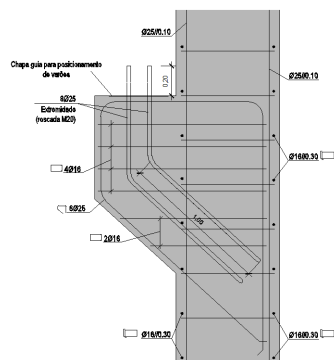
Detalhe de armaduras na zona de ligação dos IPE600 de apoio da ponte rolante à estrutura de betão.
